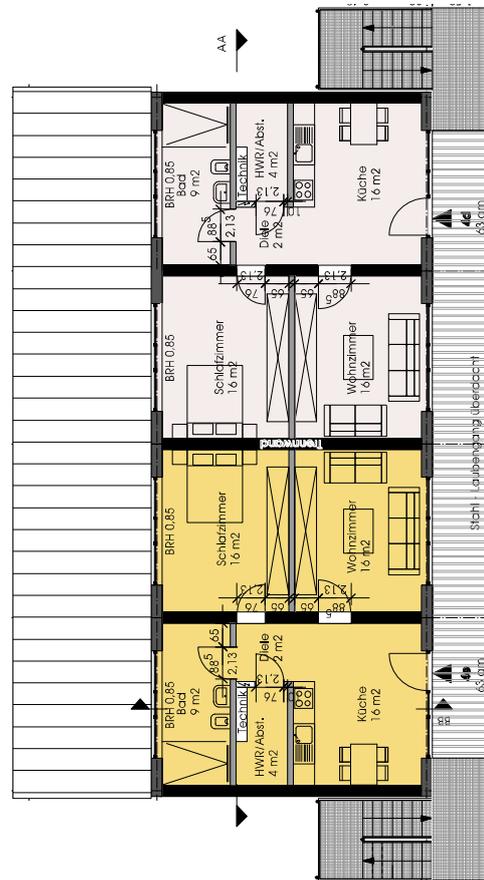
GUTZEIT (2017): Grundriss erster Stock
